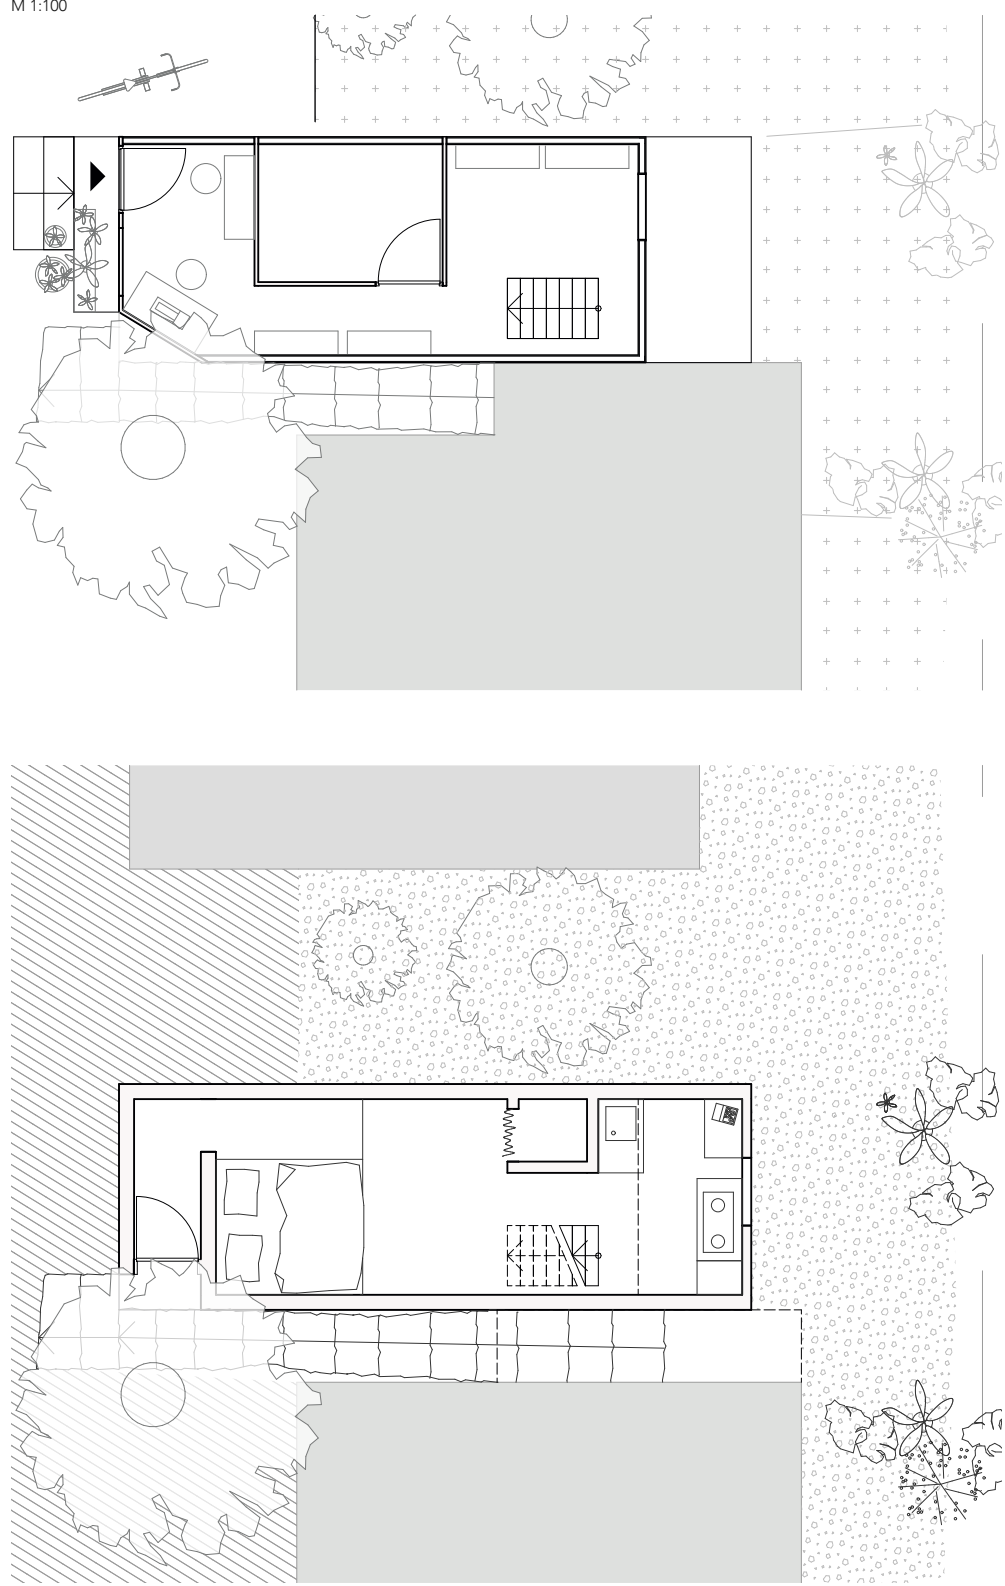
| Schematischer Grundriss von Lermas Haus
